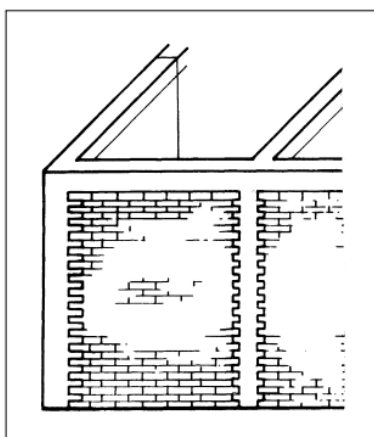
Estructura de hormigón armado con relleno de mampostería
